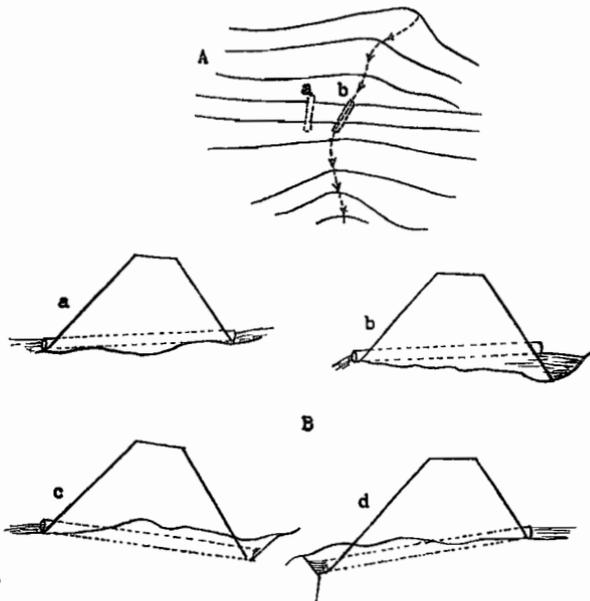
A, traversée d'une route : a., disposition incorrecte d'un caniveau sous une route, vue en plan ; b., disposition correcte suivant la ligne de plus grande pente. — B, coupe transversale d'un canal de traversée de route : a., pente correcte ; b., tuyau trop haut en amont, rétention d'eau ; c., tuyau trop bas en amont, inefficacité presque totale ; d., tuyau trop bas en aval ; érosion et formation d'une cuvette au débouché.
